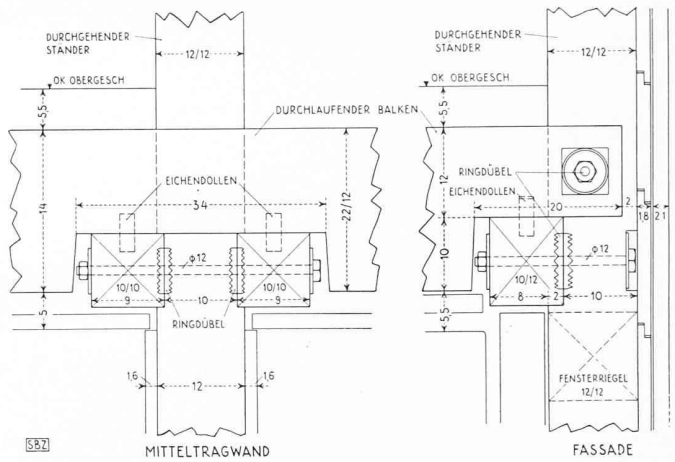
Anschluss der Balken an die durchgehenden Ständer; Detail 1:10
